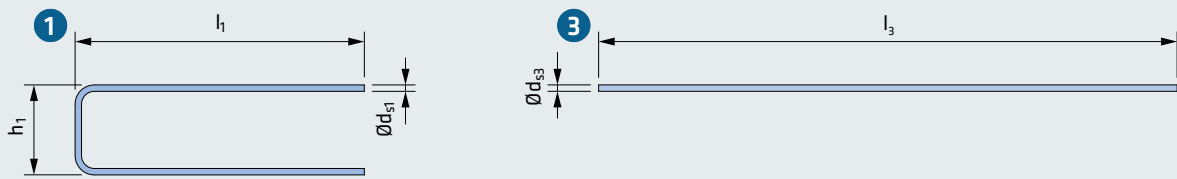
Bauseitige Bewehrung für TreDo PD30 in der Bauteilmitte
